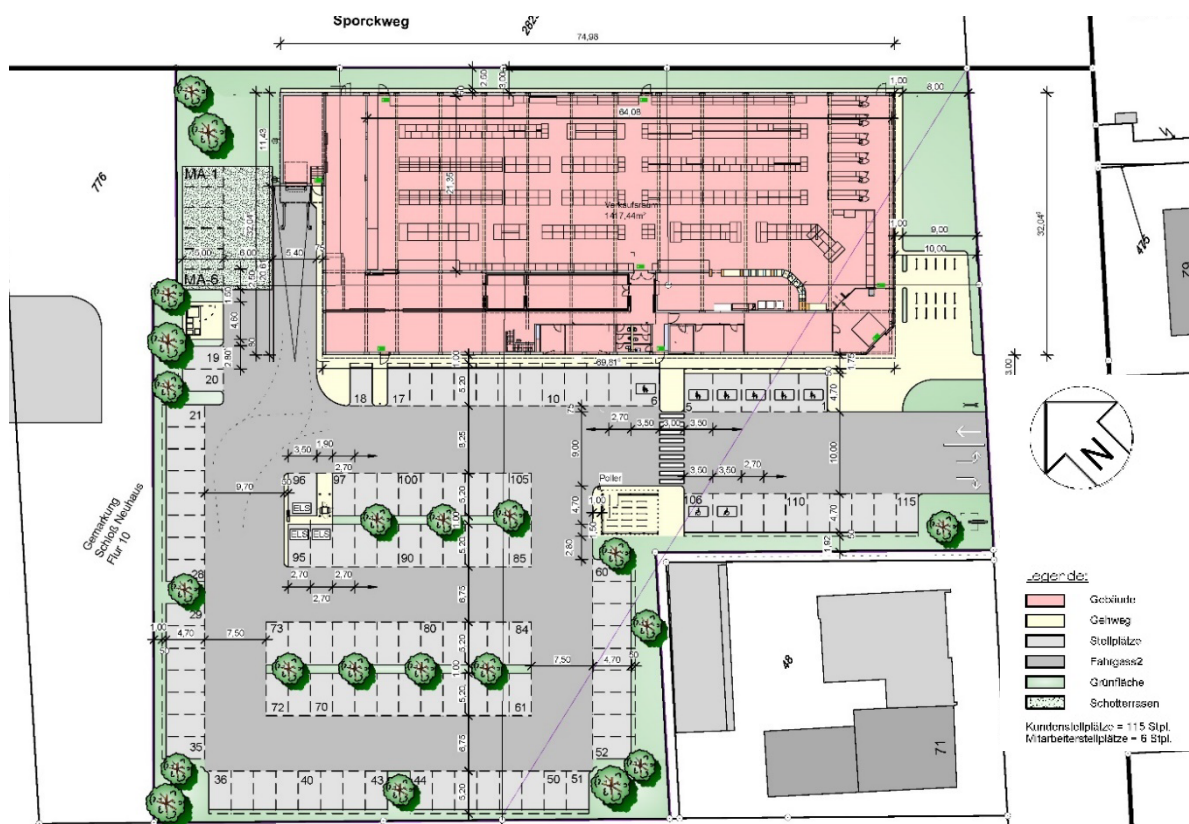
Lageplan / Vorhaben- und Erschließungsplan, o. M. (Quelle: ac Planungsbüro Soltau GmbH, Soltau, 11/2022)
